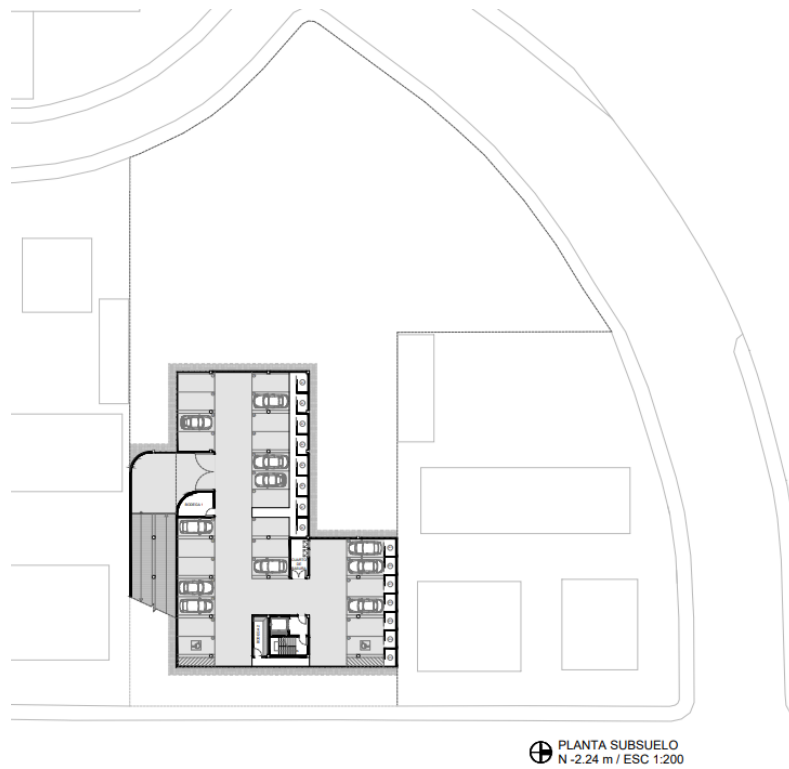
Planimetría: Planta Subsuelo (N -2.24 m)
